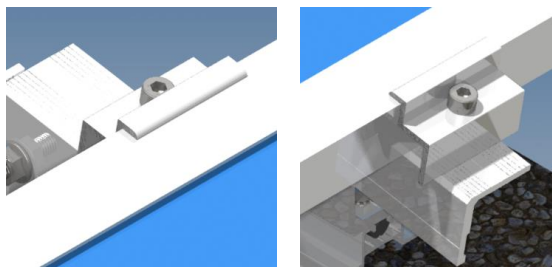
Detalle Brida Extremo para la fijación de las placas fotovoltaicas
